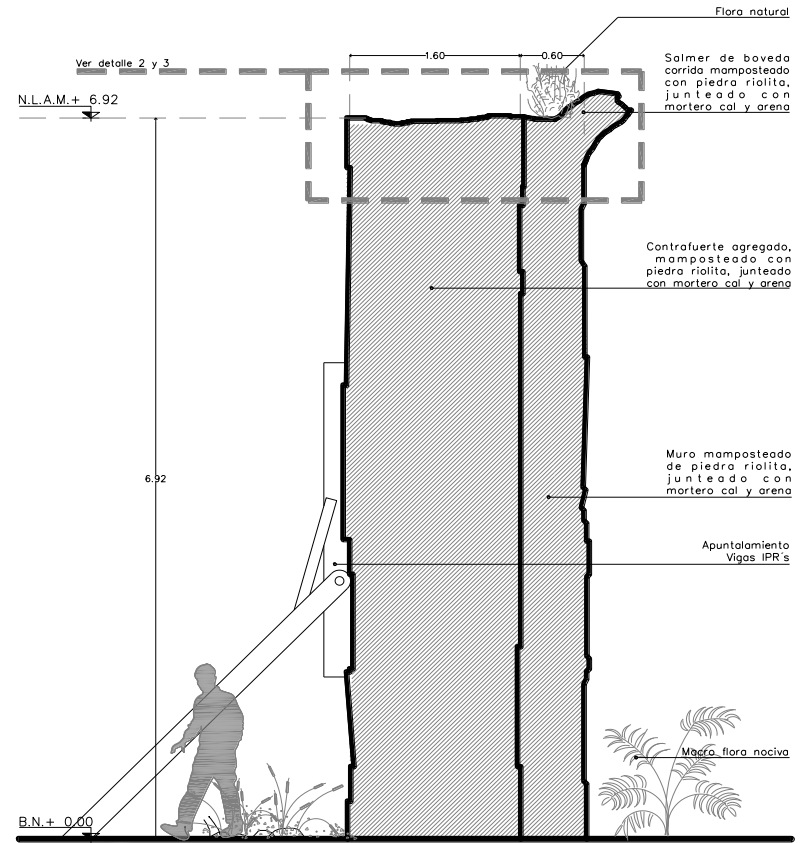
Dibujo arquitectónico, detalle de contrafuerte agregado con apuntalamiento. Ver anexo de planos EA_007. 2017.
